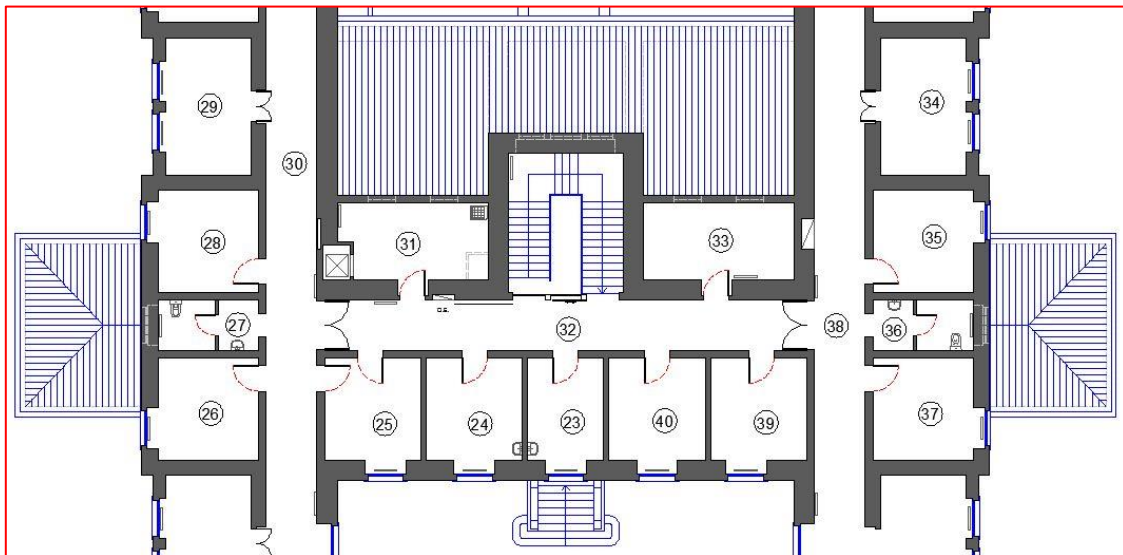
Planta do piso 1 do núcleo central do Pavilhão 16A.
